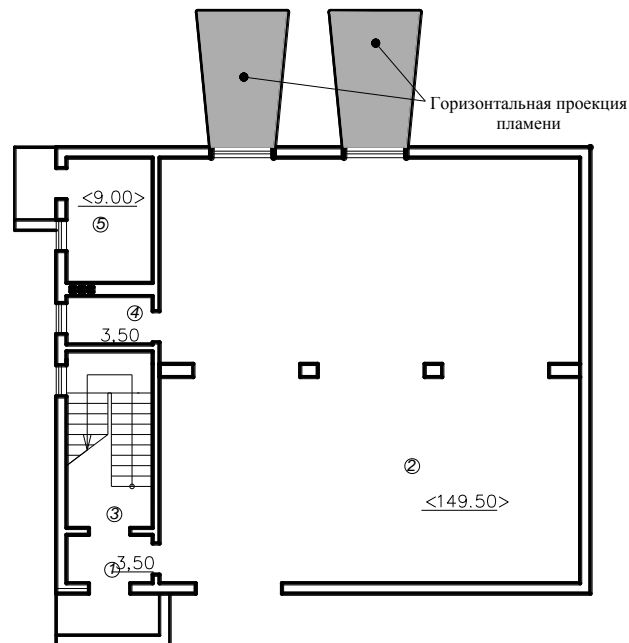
Горизонтальная проекция фронта пламени из проемов производственного помещения (поз.2 план на отм. 0.000)
